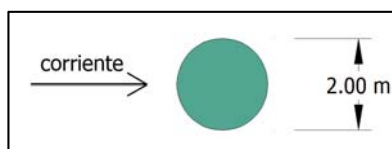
9, Sección de Pila puente “Samán”.^{PA}
